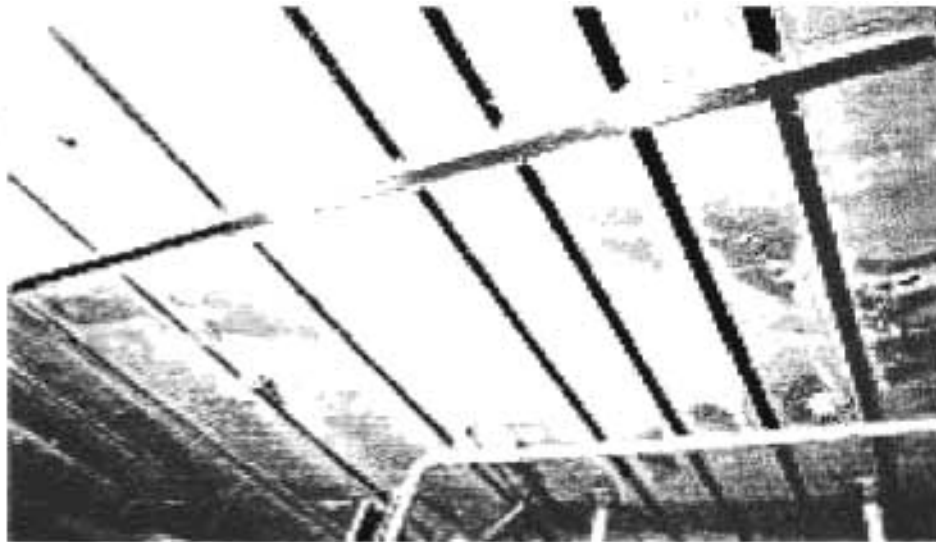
Paneles de tipo cerámica sinterizado para la construcción de techos y entrepisos
